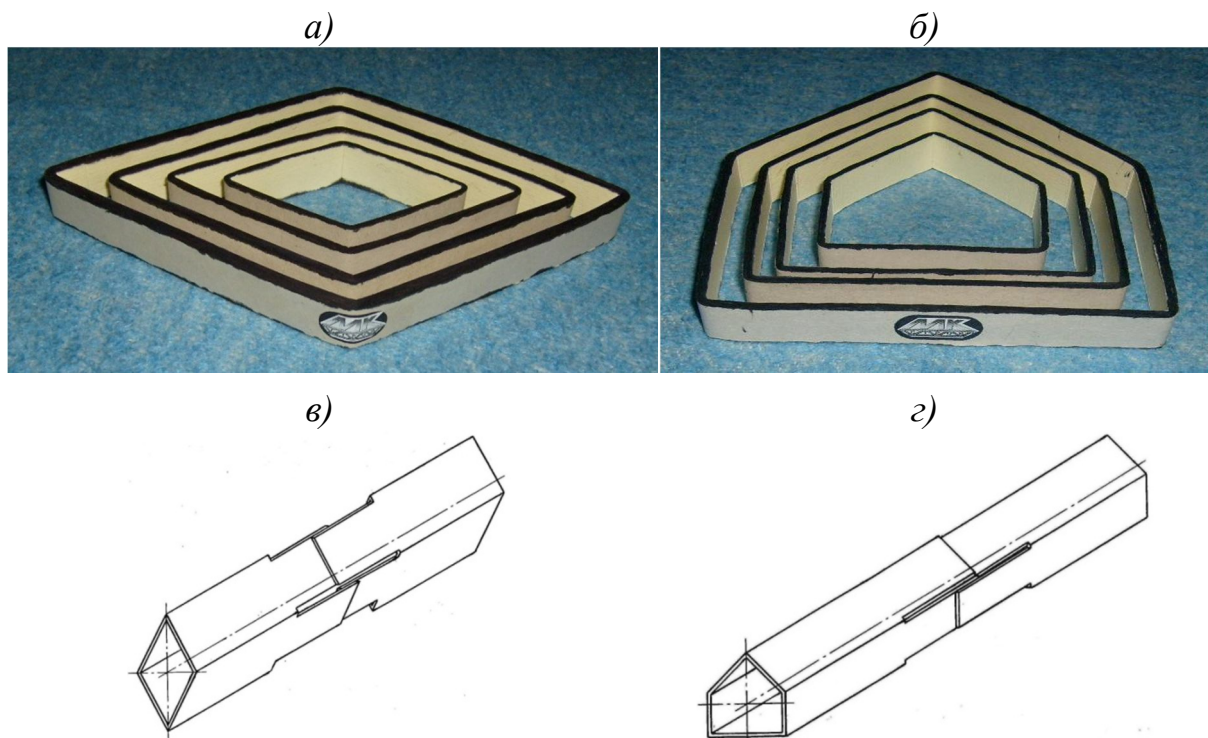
Профили поперечных сечений стержневых трубчатых элементов ромбической (а) и пятиугольной (б) формы, а также их стыковые сварные соединения в процессе монтажа (в, з)
